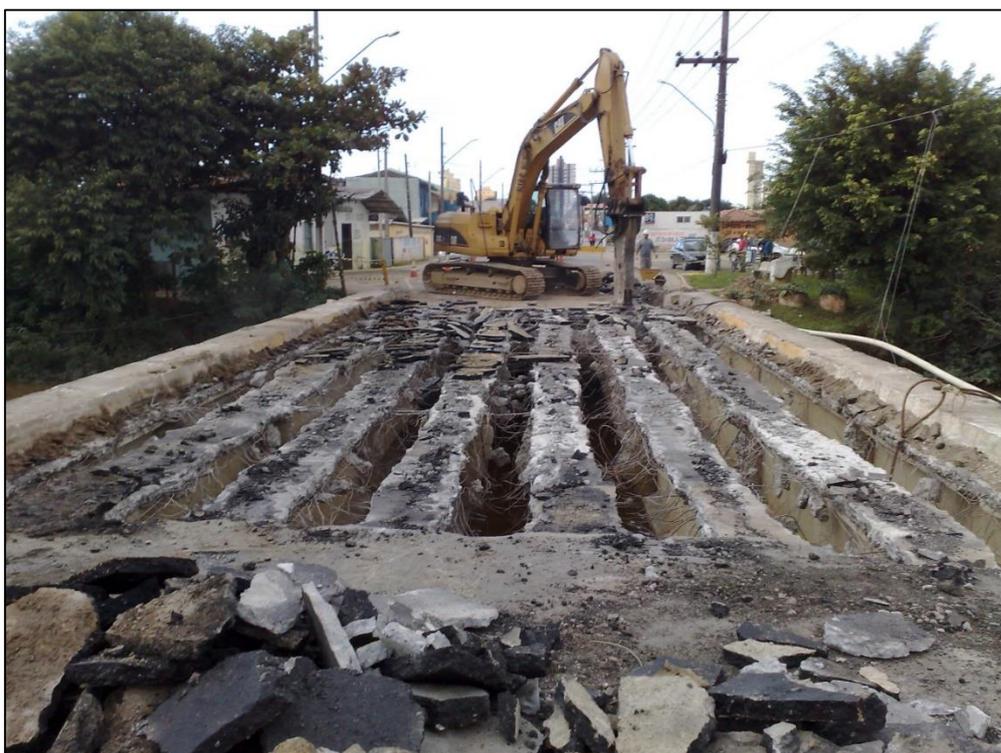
Escavadeiras rompendo e picando a estrutura de concreto armado e alvenarias.
